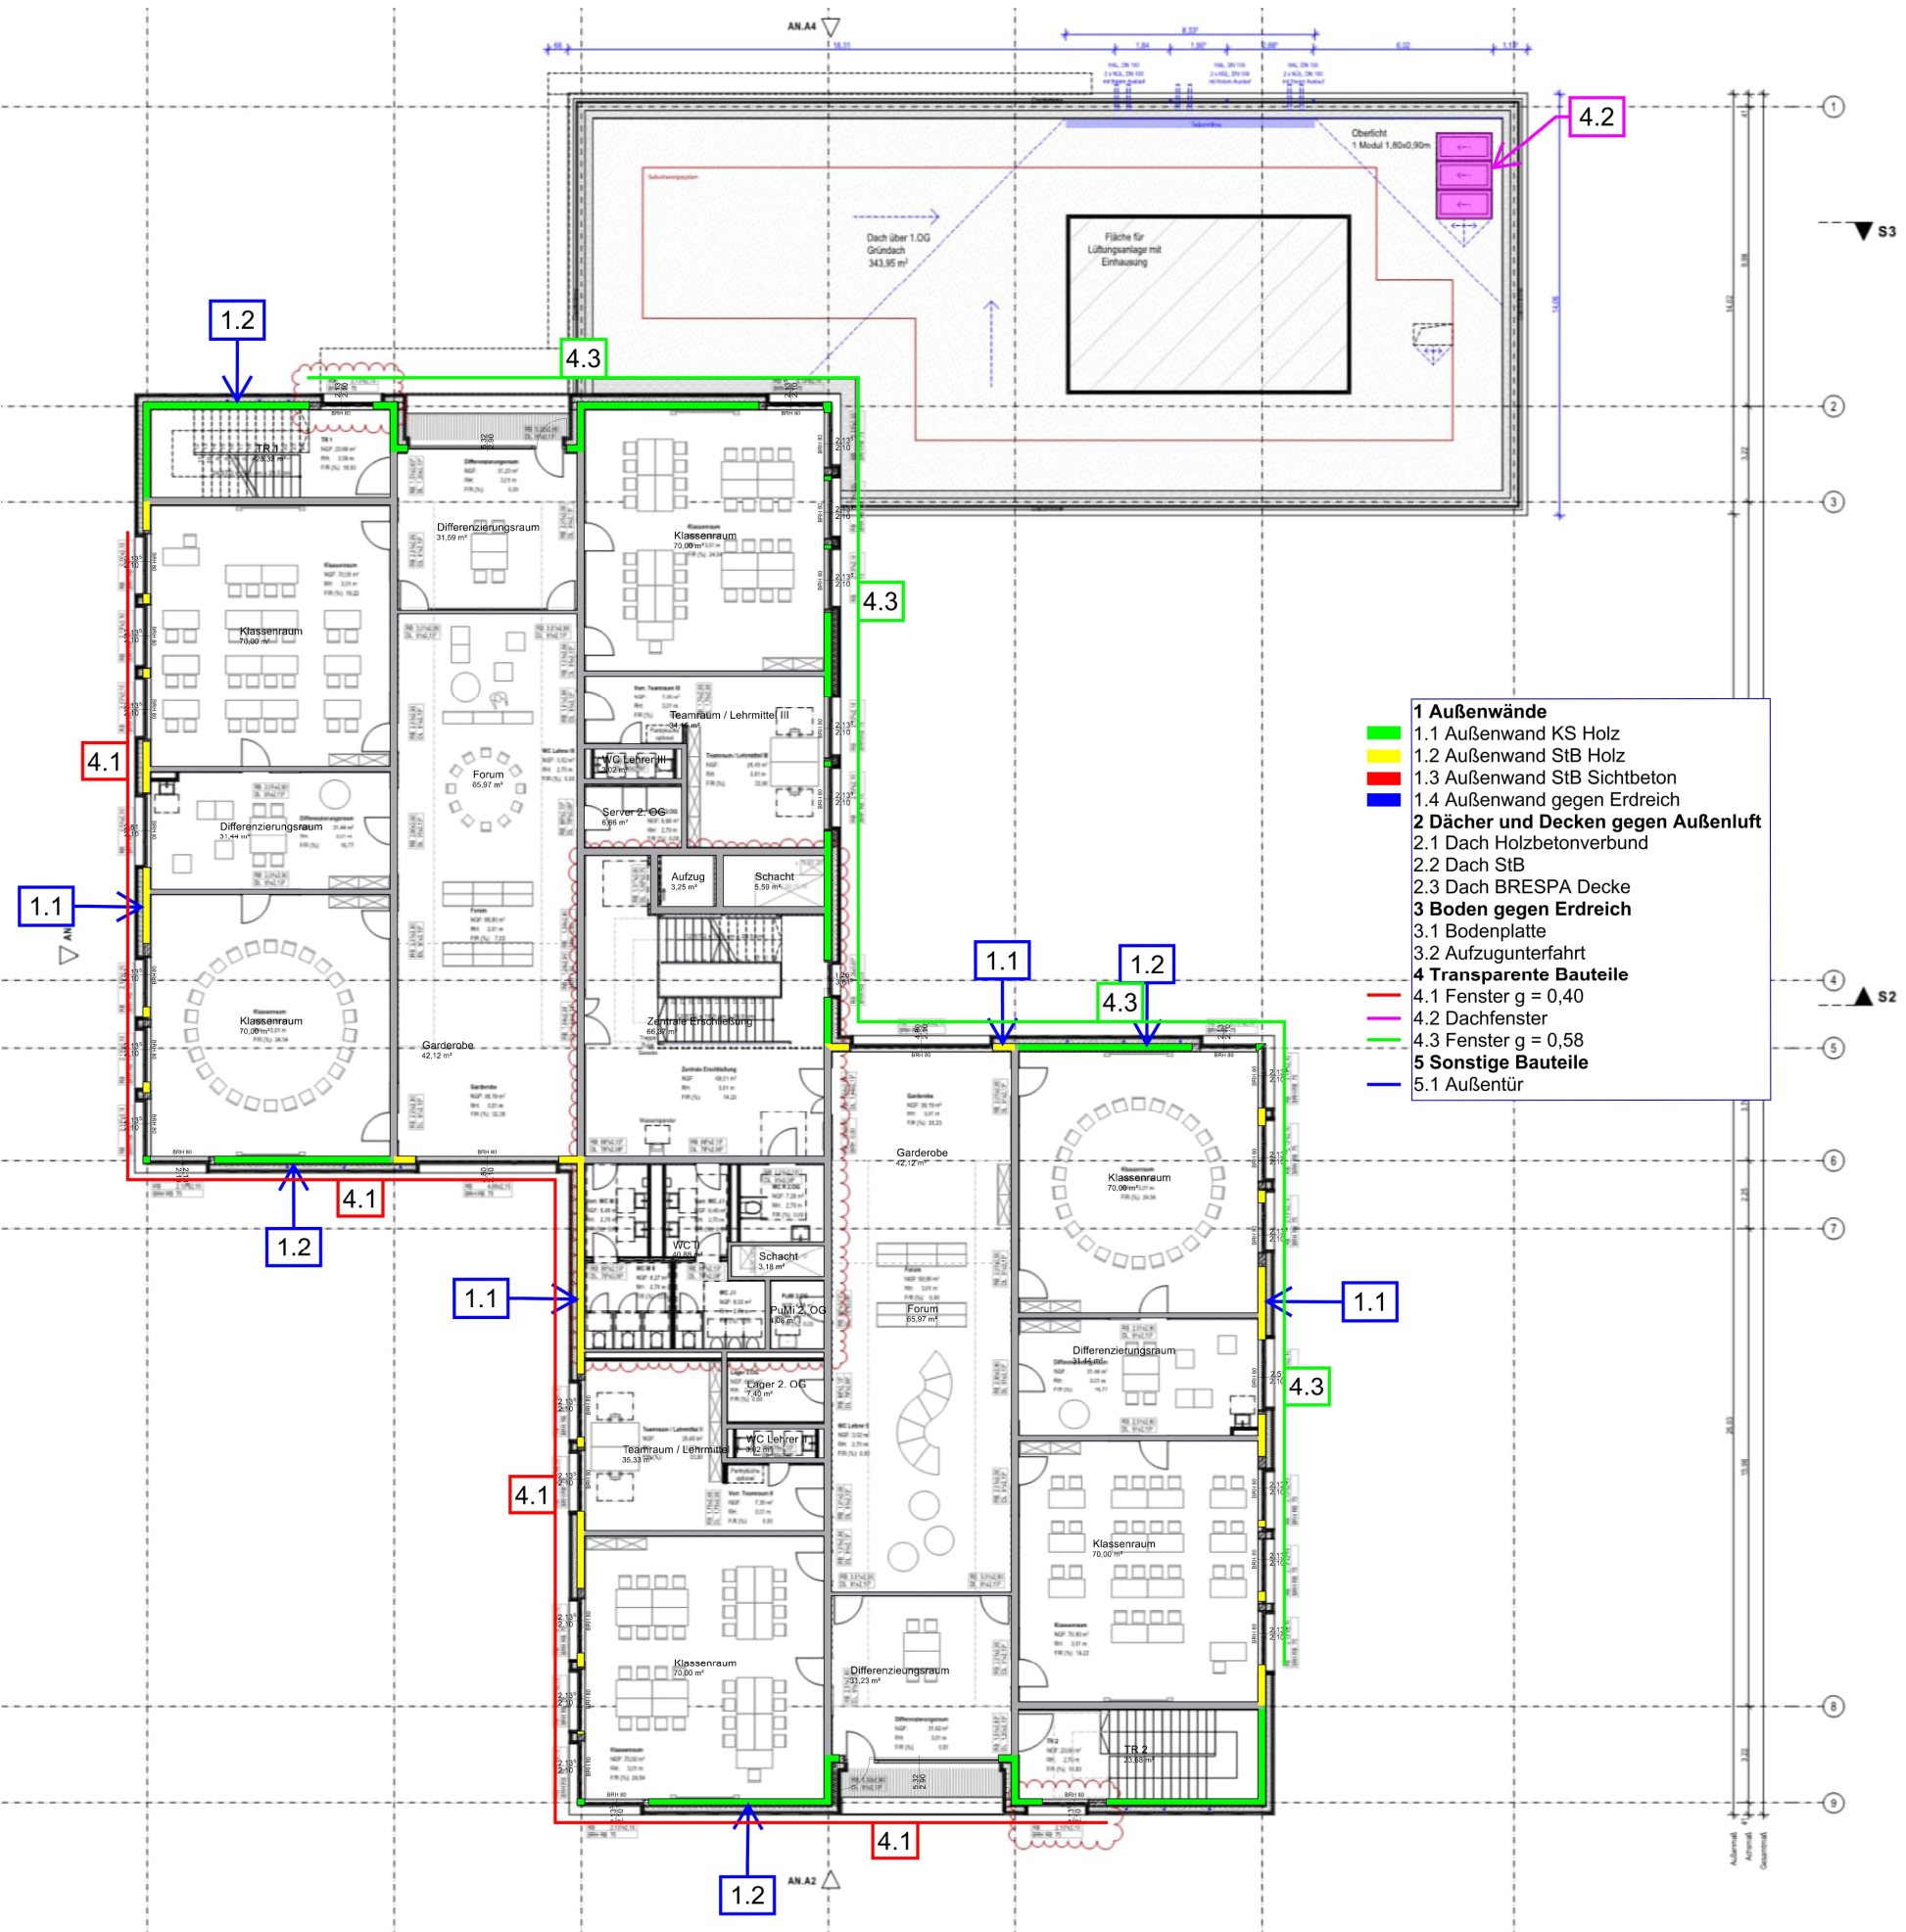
Bauteile Wände und Fenster Grundriss 2. OG
